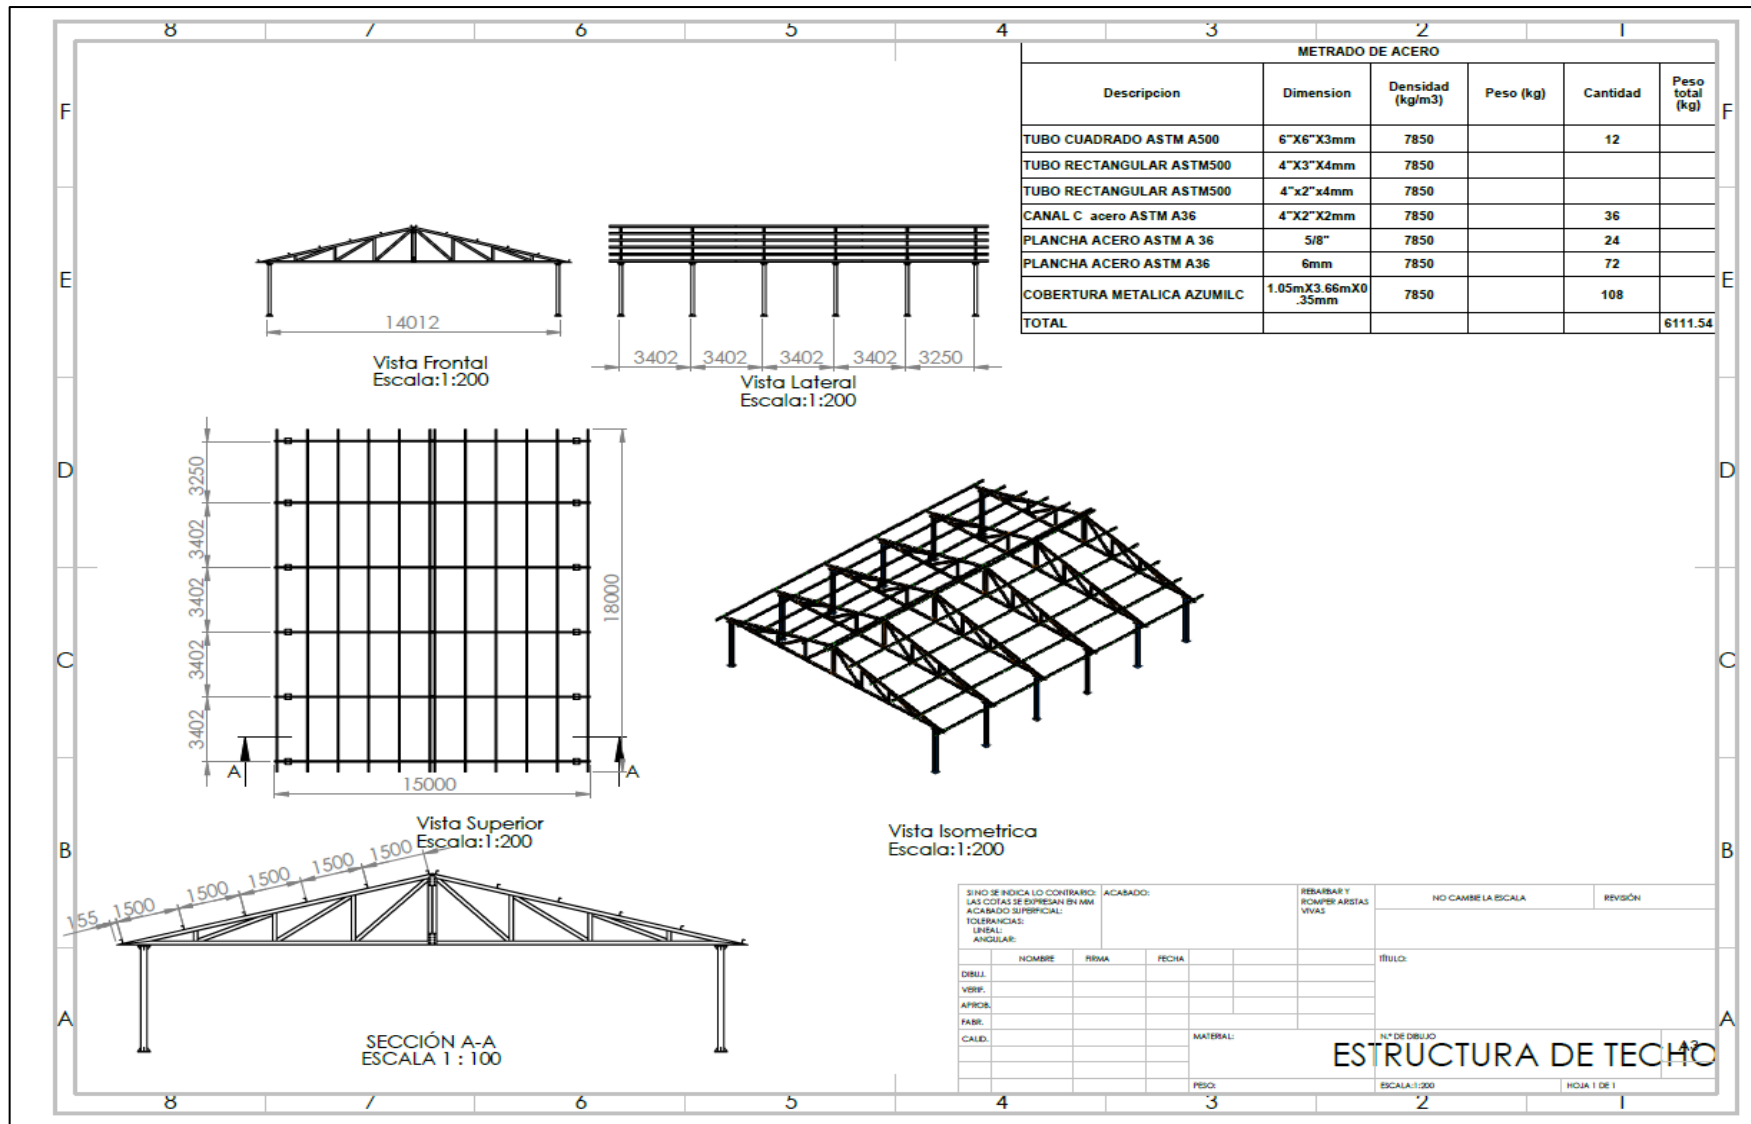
Elaboración del plano del techo estructural de las oficinas de Hidrogeología
